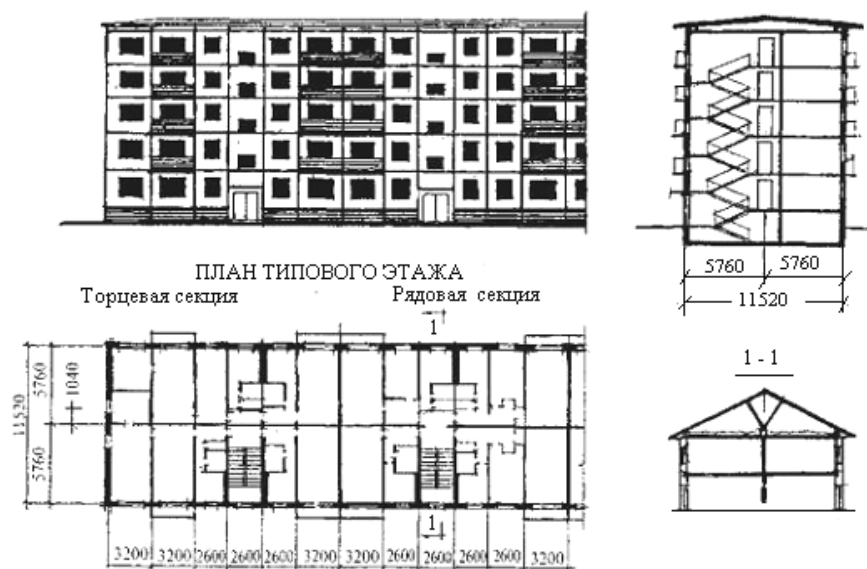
Фасад, план типового этажа и разрез крупнопанельного жилого дома серии 1-464
